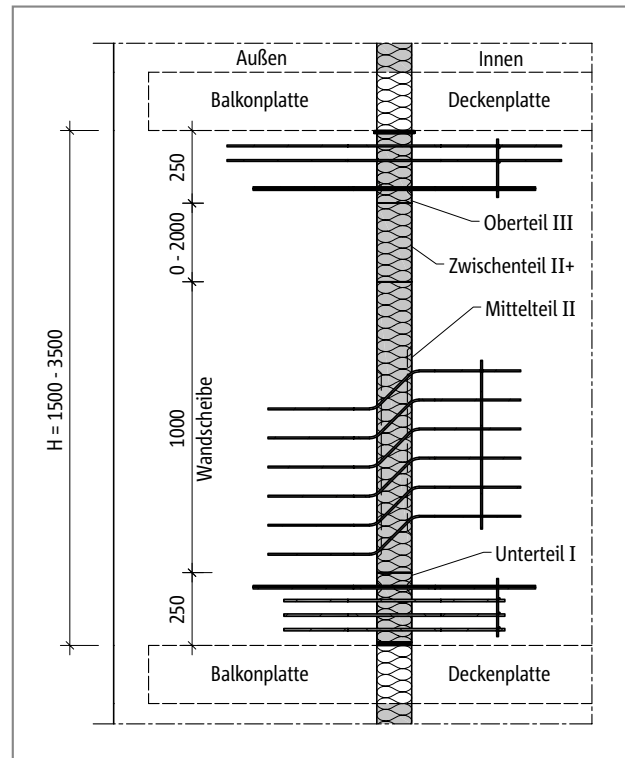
Schöck Isokorb® XT Typ W: Balkonkonstruktion mit wärmege-
